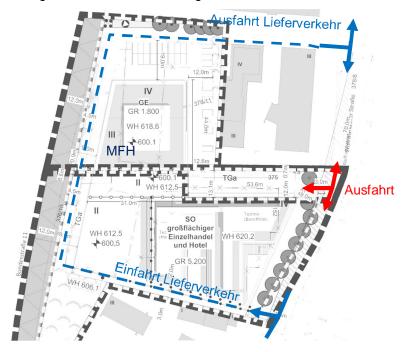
geplante Erschließung Bauvorhaben (Quelle Lageplan: paterre GmbH)
